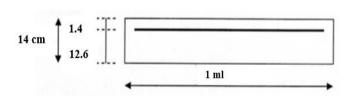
Schéma de ferraillage de la dalle machine.
